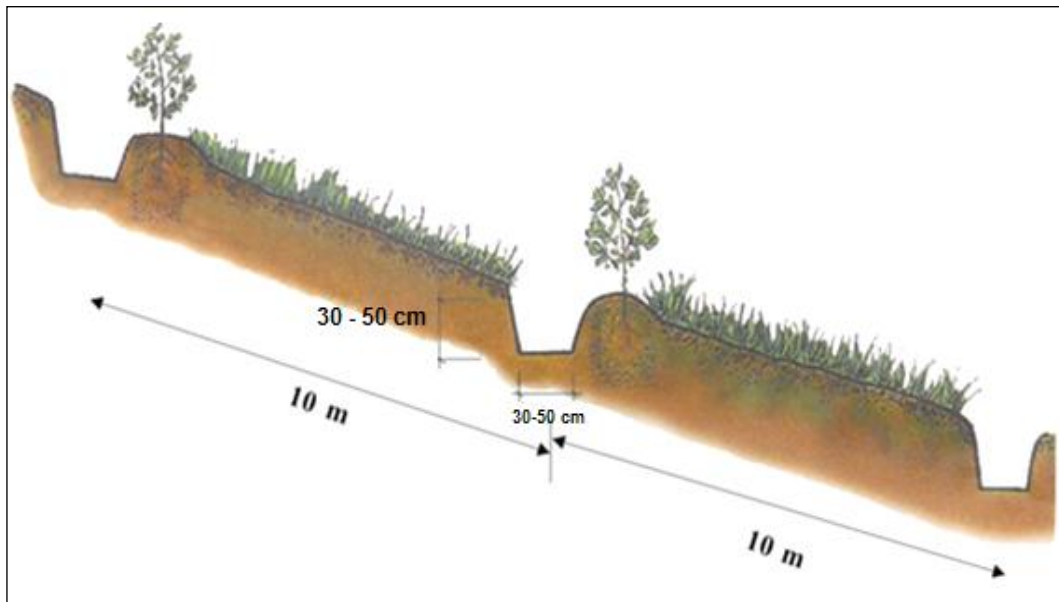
Corte de una plantación forestal con acequias de infiltración
